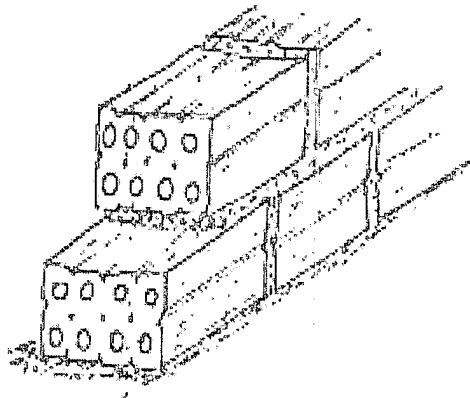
Execução de alvenaria de 1 vez, utilizando tijolos furados.
